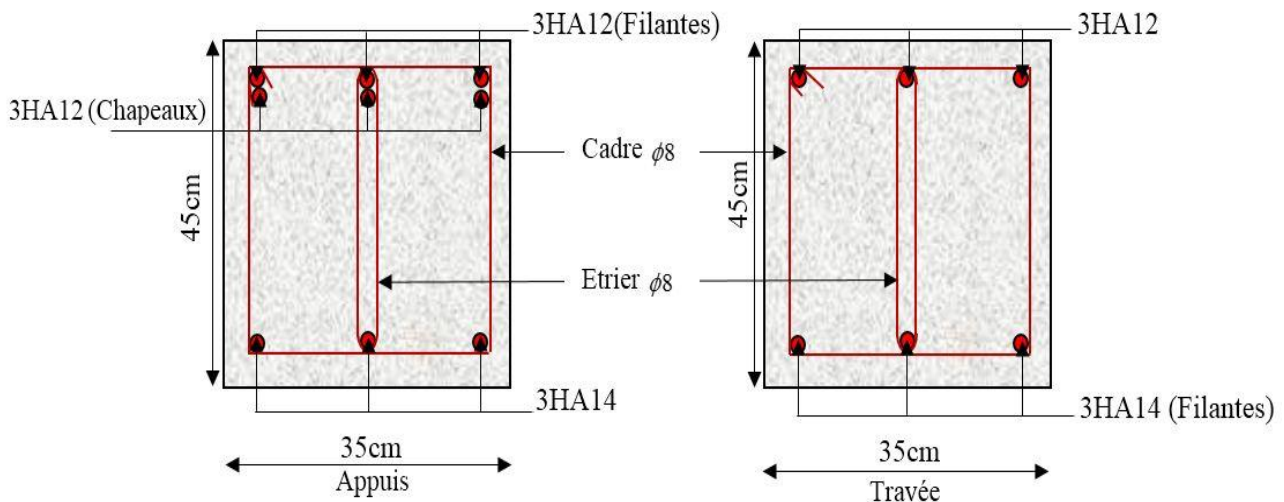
Schéma de ferrailage de la poutre principale du RDC.
